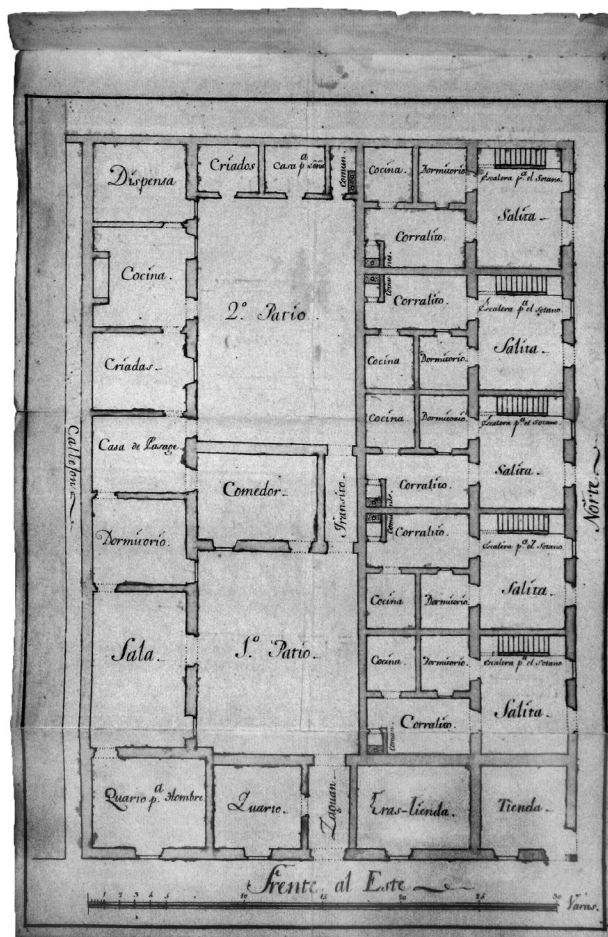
Plano de la planta de la casa de don Juan José Castro, barrio de la Merced.<sup>49</sup>
